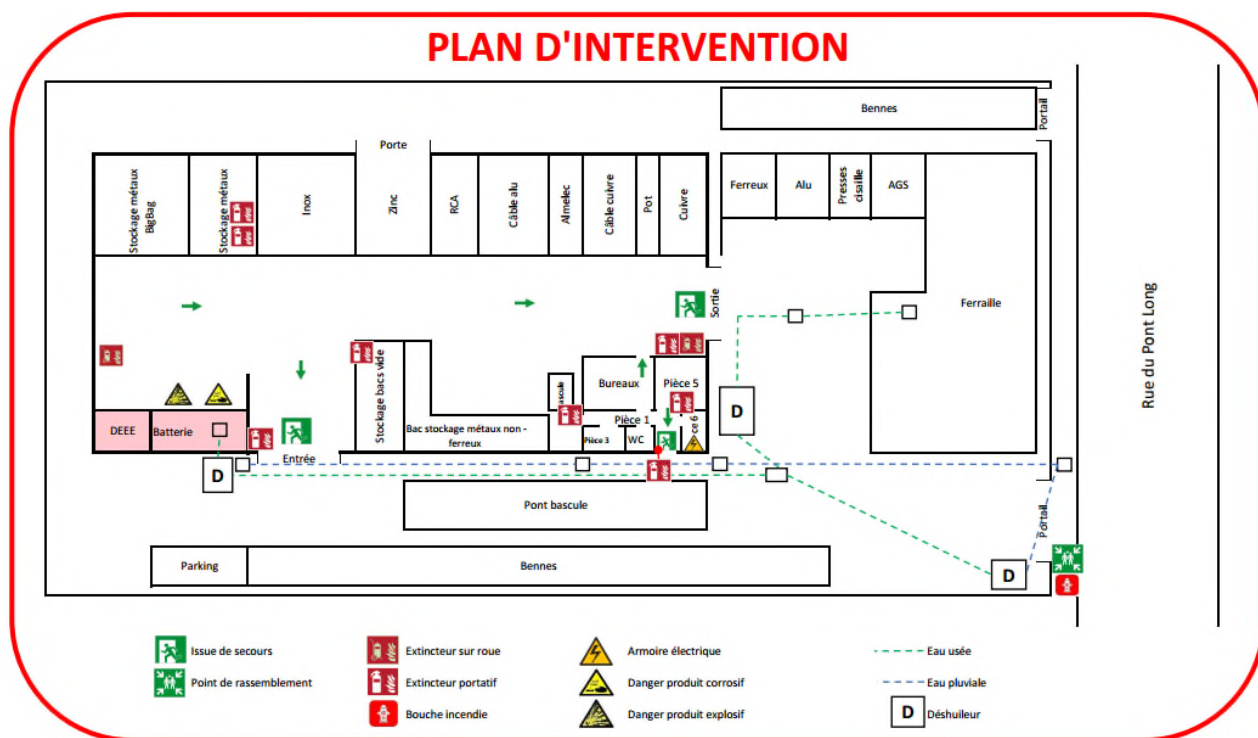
Plan du site actuel avec futurs déshuileurs (Source : Client)
